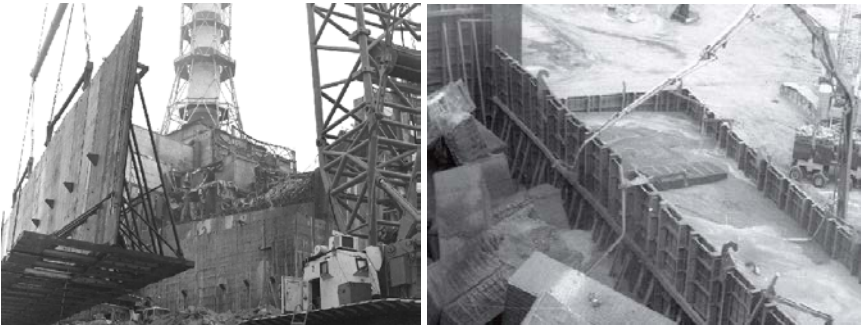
Монтаж опалубки каскадной стены и заливка бетоном
